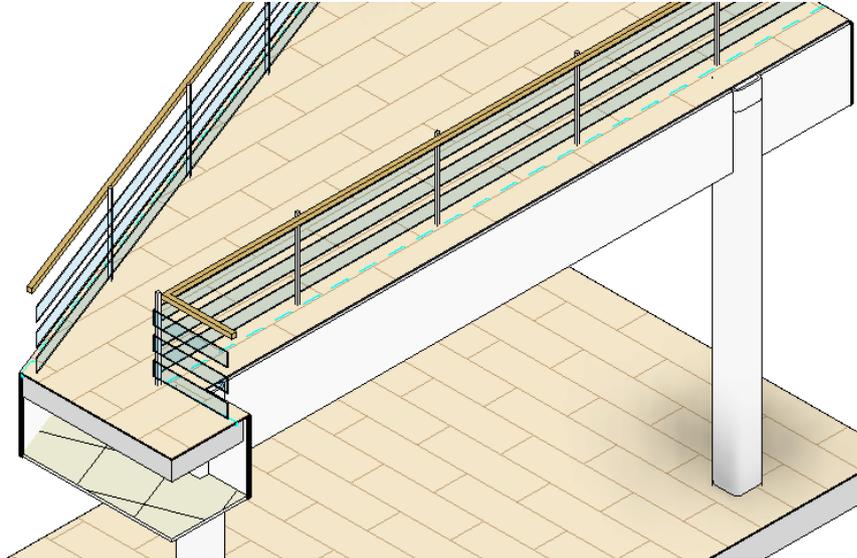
Cielo Razo primera planta n+0.10m
